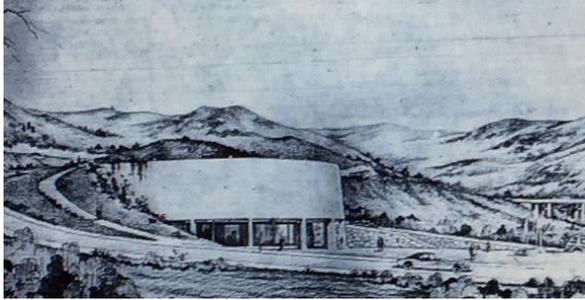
Propuesta de ciclorama para el Puente de Boyacá
